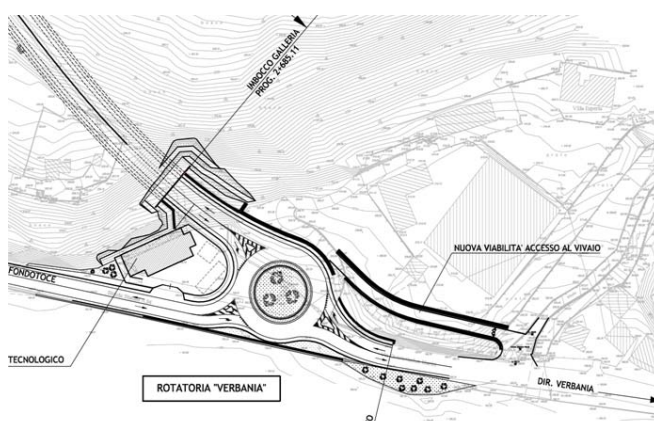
Planimetria dell'imbocco in galleria est lato Verbania
